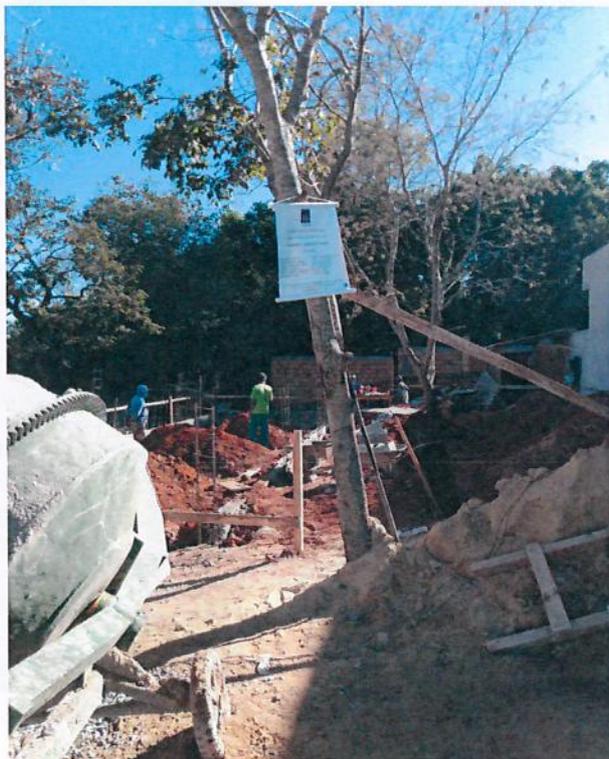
destaque para as duas aroeiras do sertão, à da frente no alinhamento do muro divisório.
